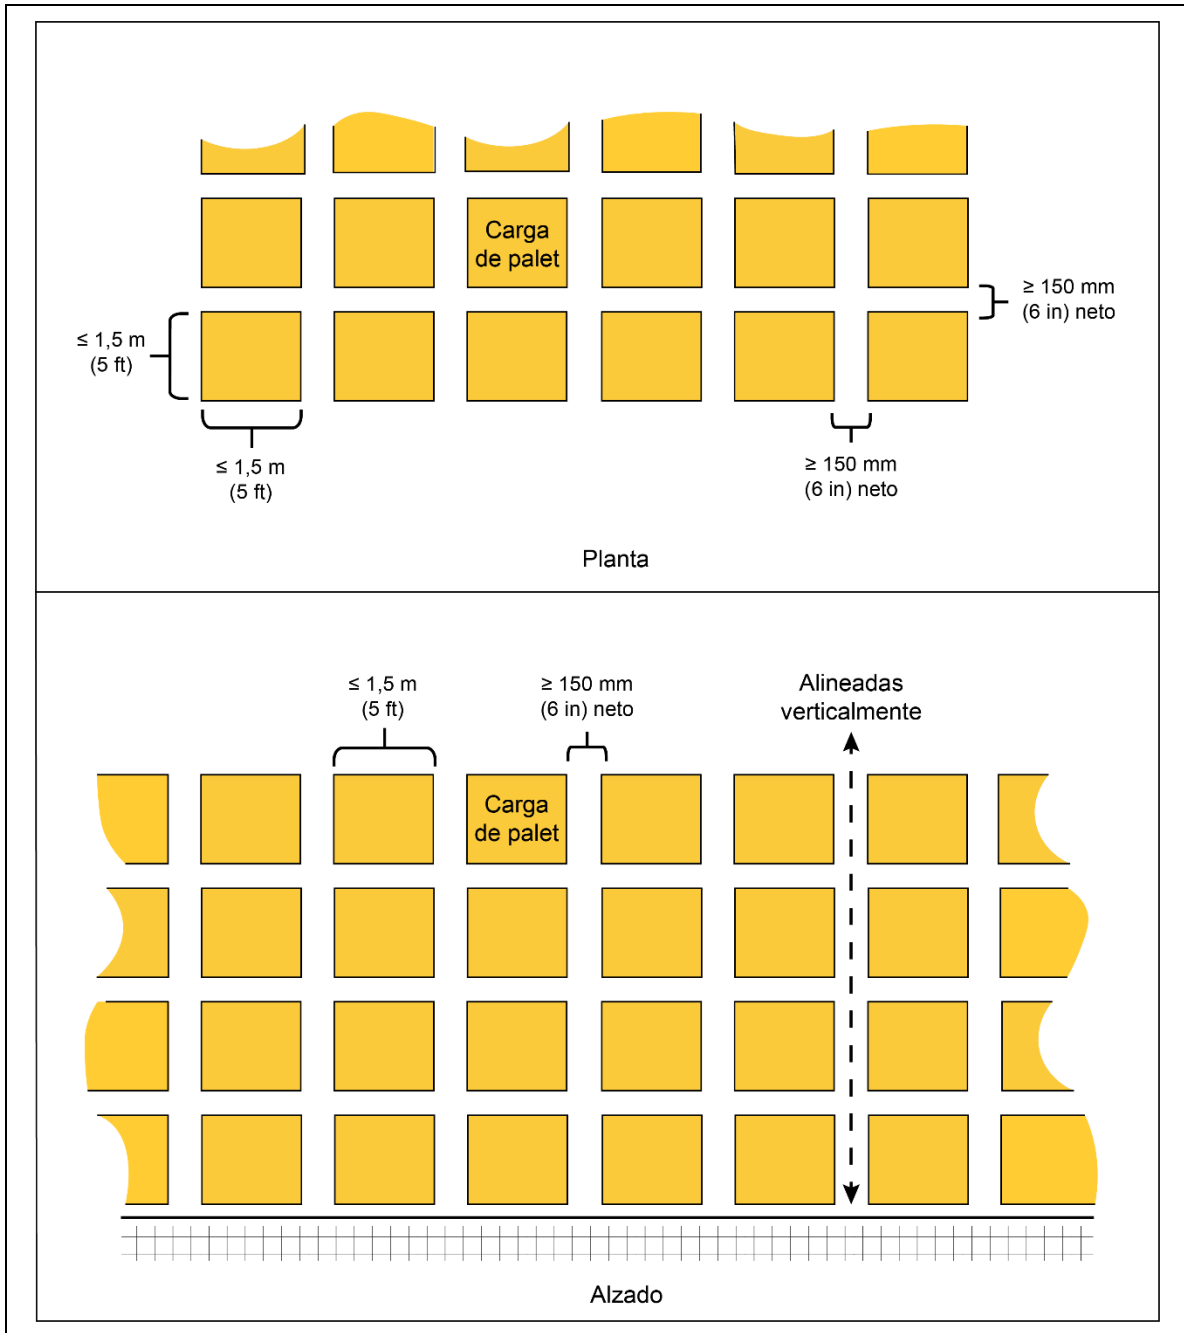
Configuración aceptable de las chimeneas transversales para estanterías múltiples abiertas, Opción 1
